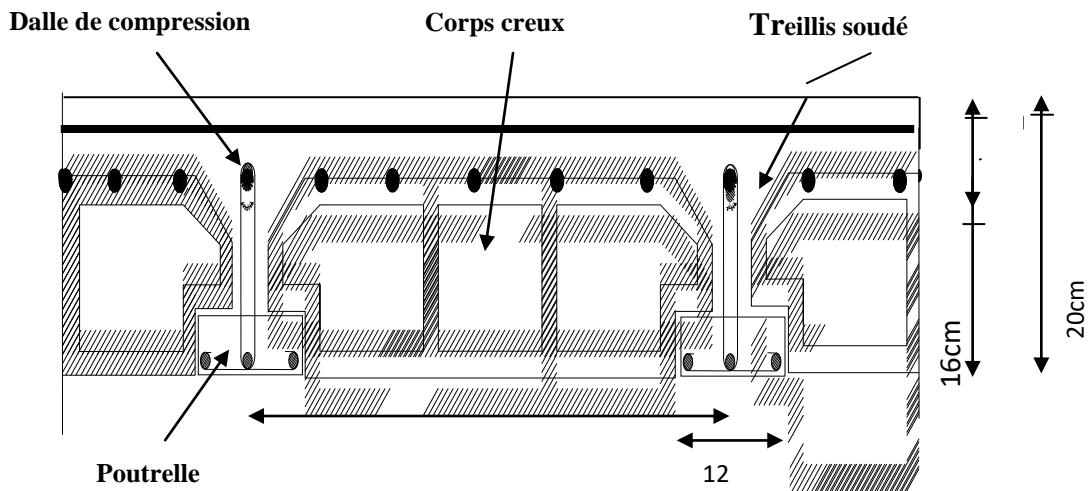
Schéma descriptif d'un plancher en corps creux.
